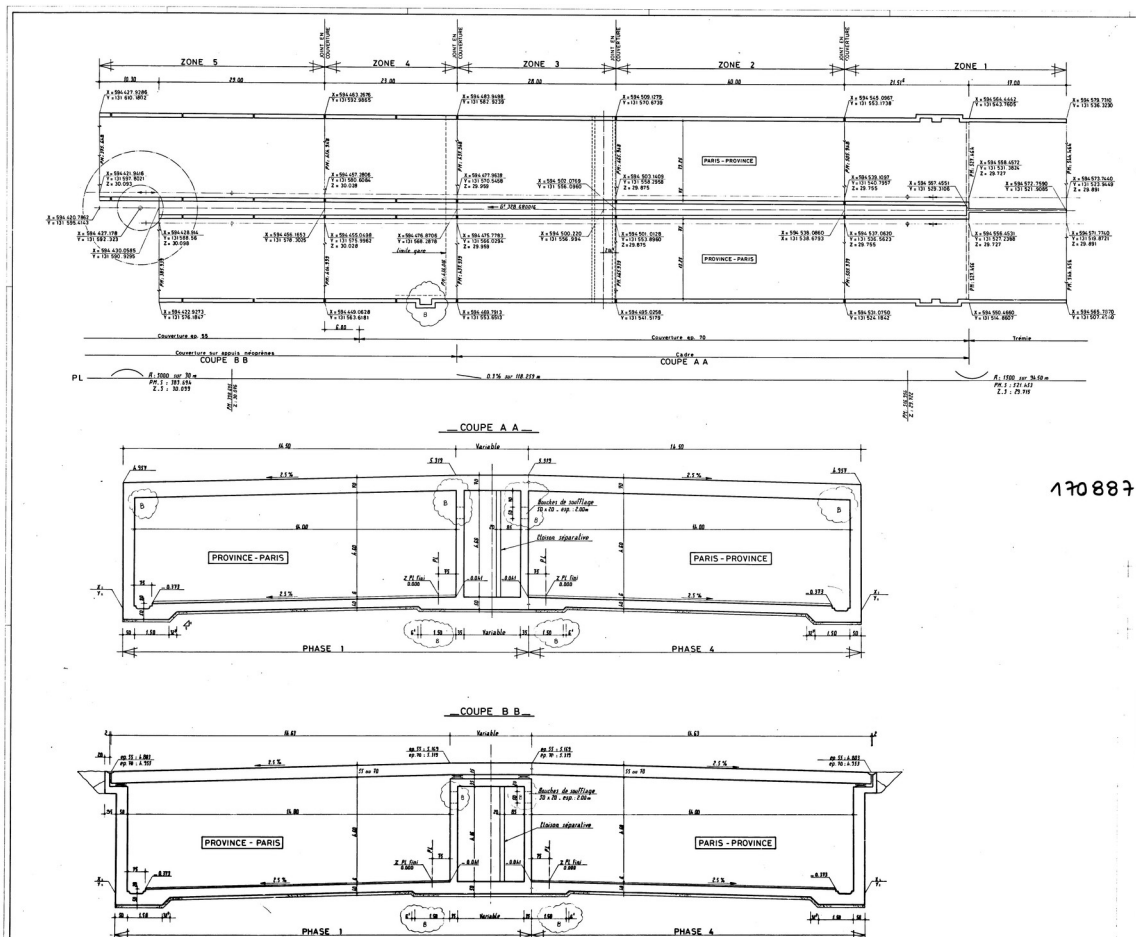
Coupe transversale du cadre en Zone 2 (plan 170888)
